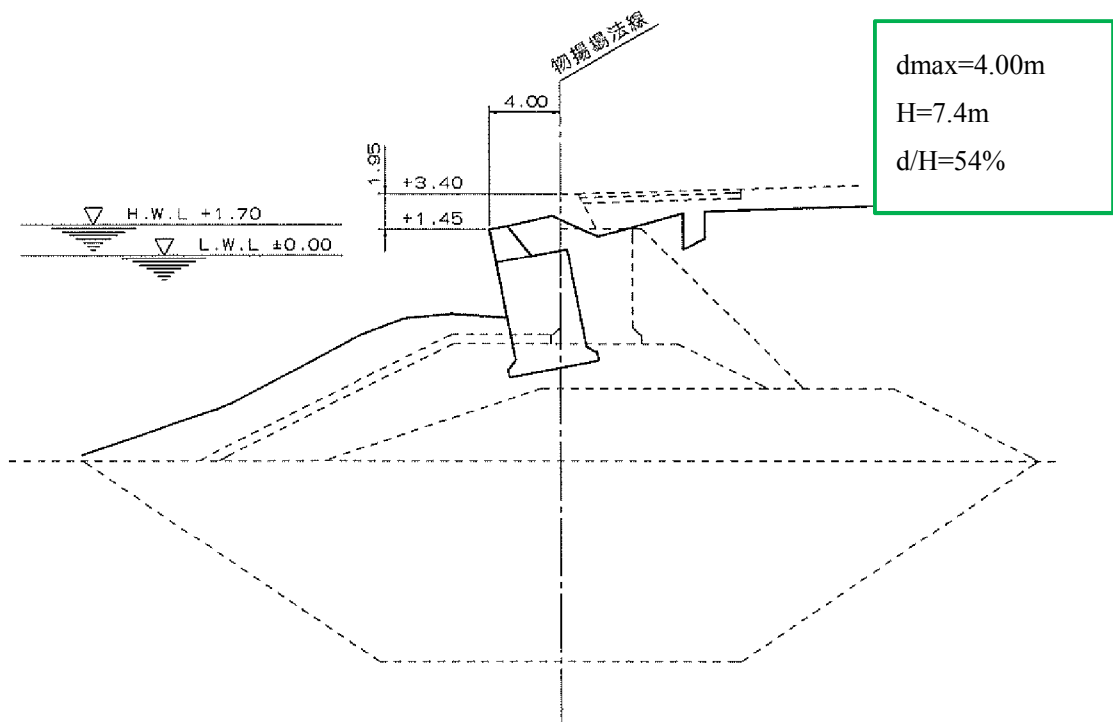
物揚場その1 (南) (-4m) ⑦標準断面図及び被災状況断面図
